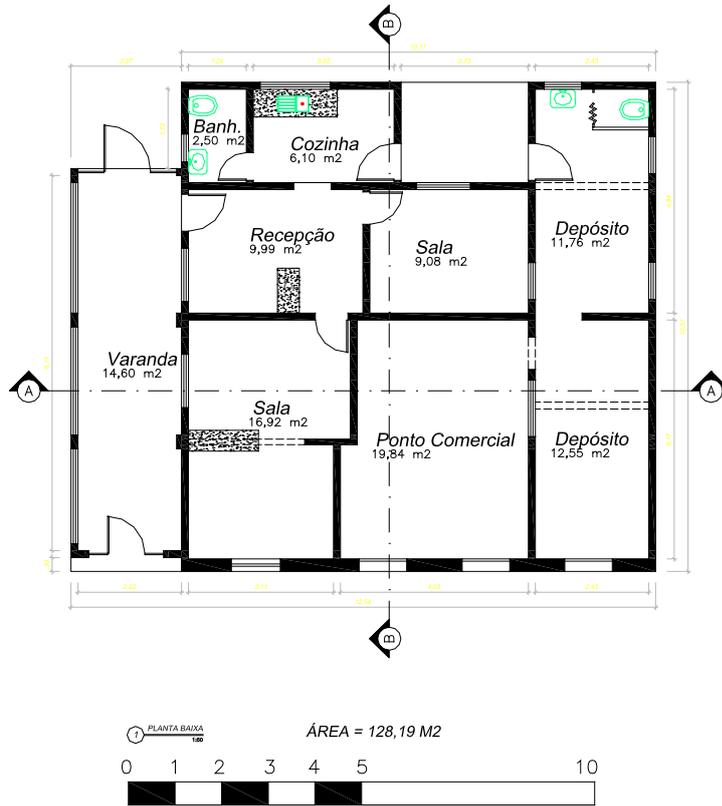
Planta pavimento térreo - Casa Antônio Tuão
